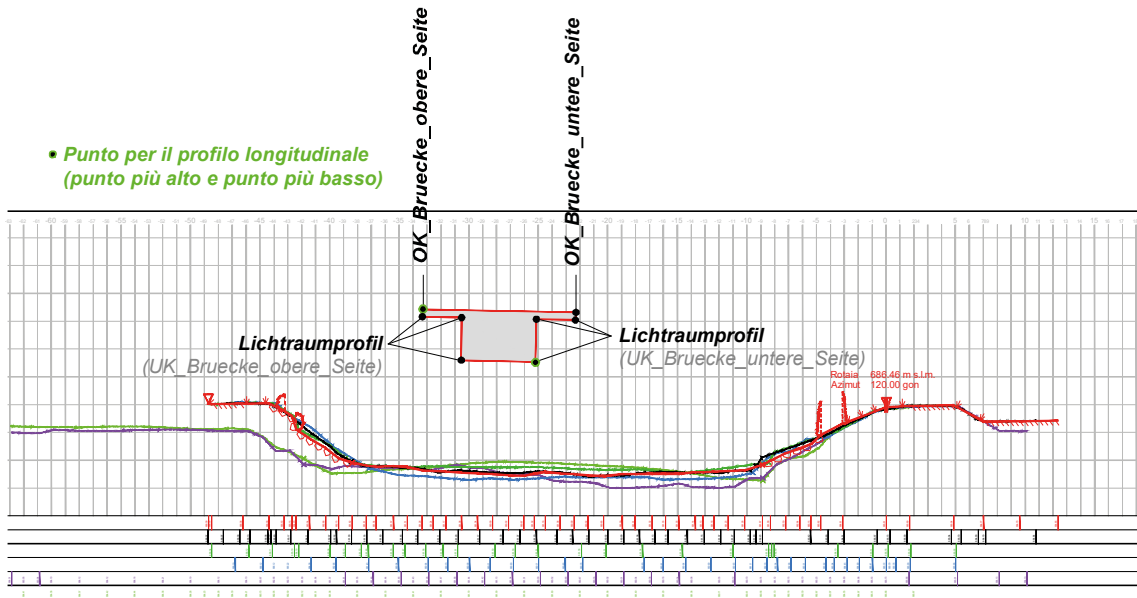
Esempio sezioni di un ponte, profilo trasversale GEWISS-Adr. 218566.
